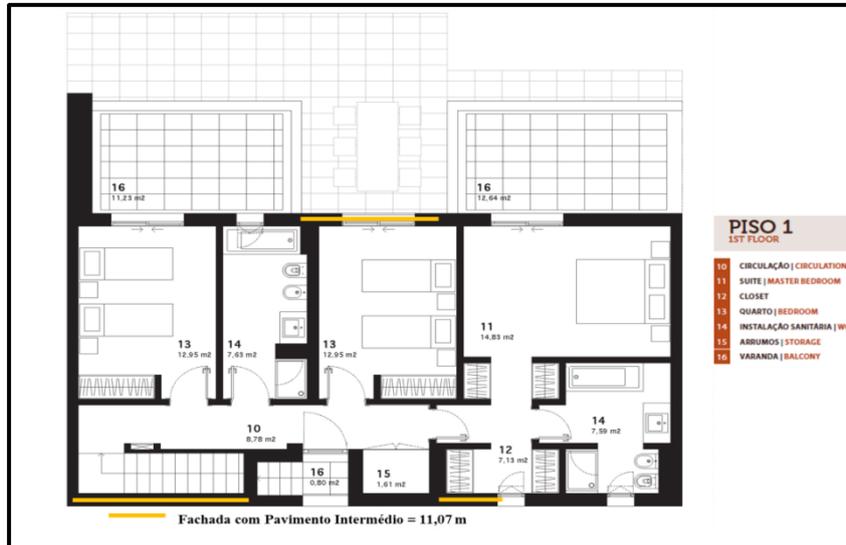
PTL – Fachada com Pavimento Intermédio
